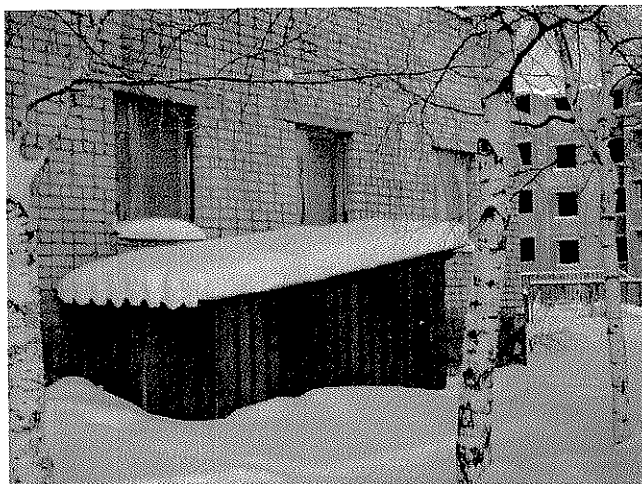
и №7. Фрагмент фасада по оси «12» - конструкции входа в подвал
